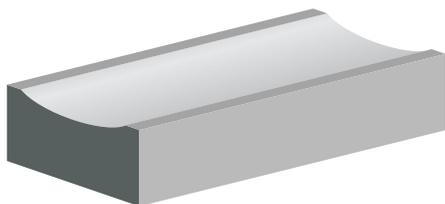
Filet d'eau en béton préfabriqué avec section circulaire
